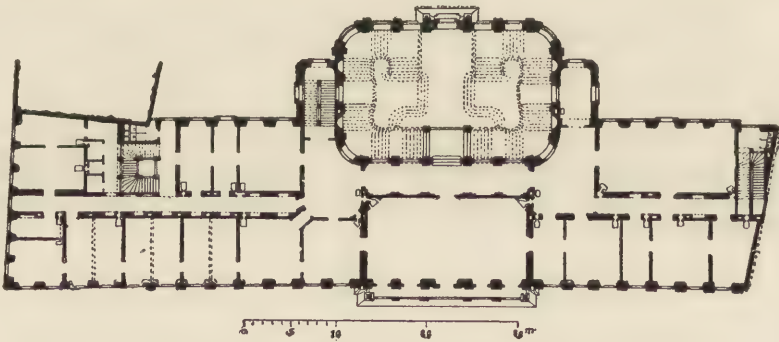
Landhaus, Grundriss des Hauptgeschosses.
